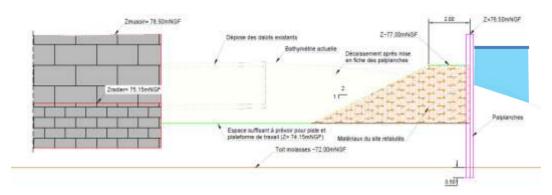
Plan de principe du fichage des palplanches (source : Egis)
